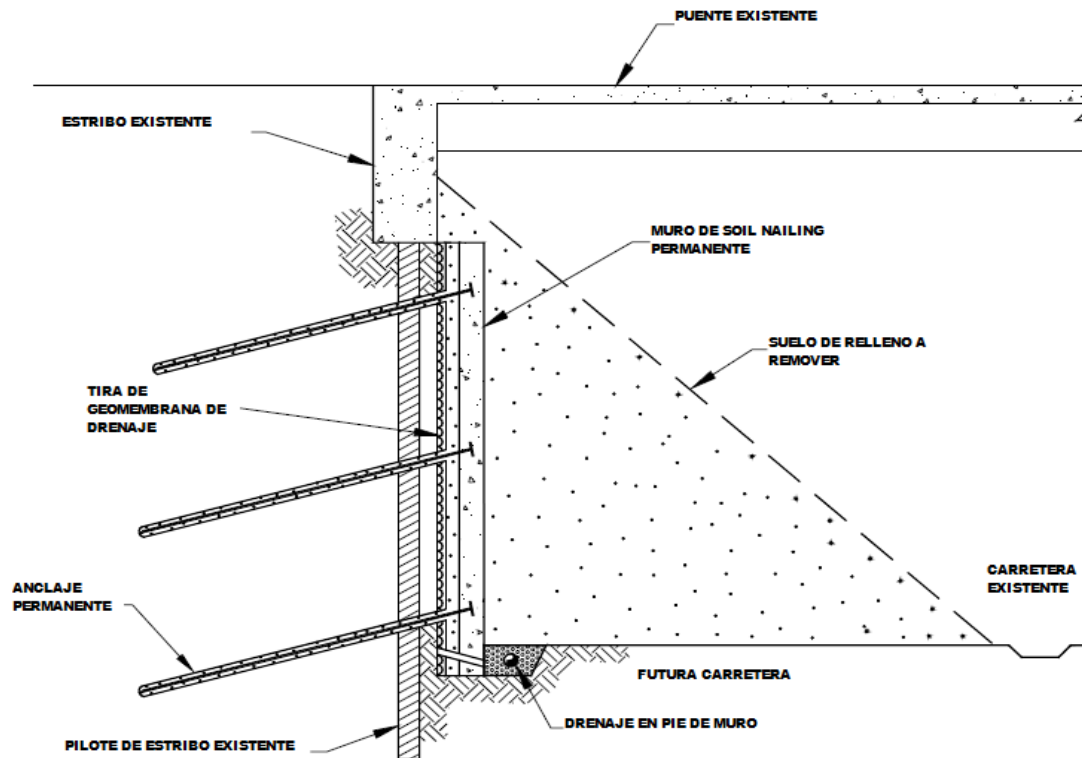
6 Muro de soil nailing en talud bajo puente existente.
